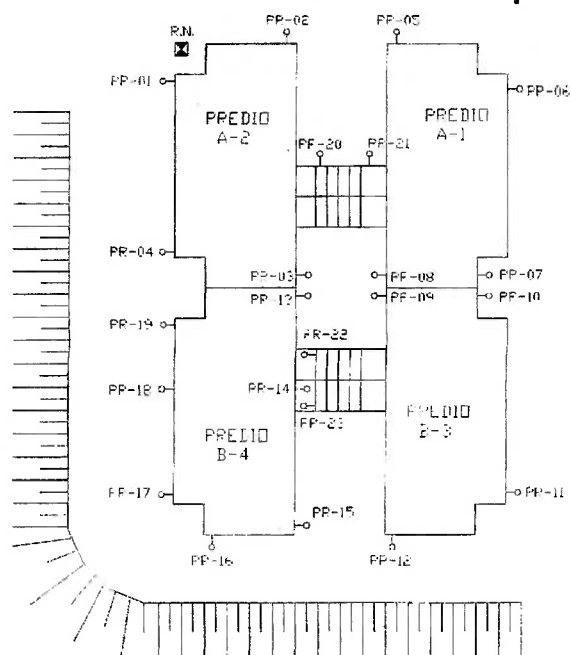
Detalhe da planta de localização dos prédios e pinos de instrumentação.
